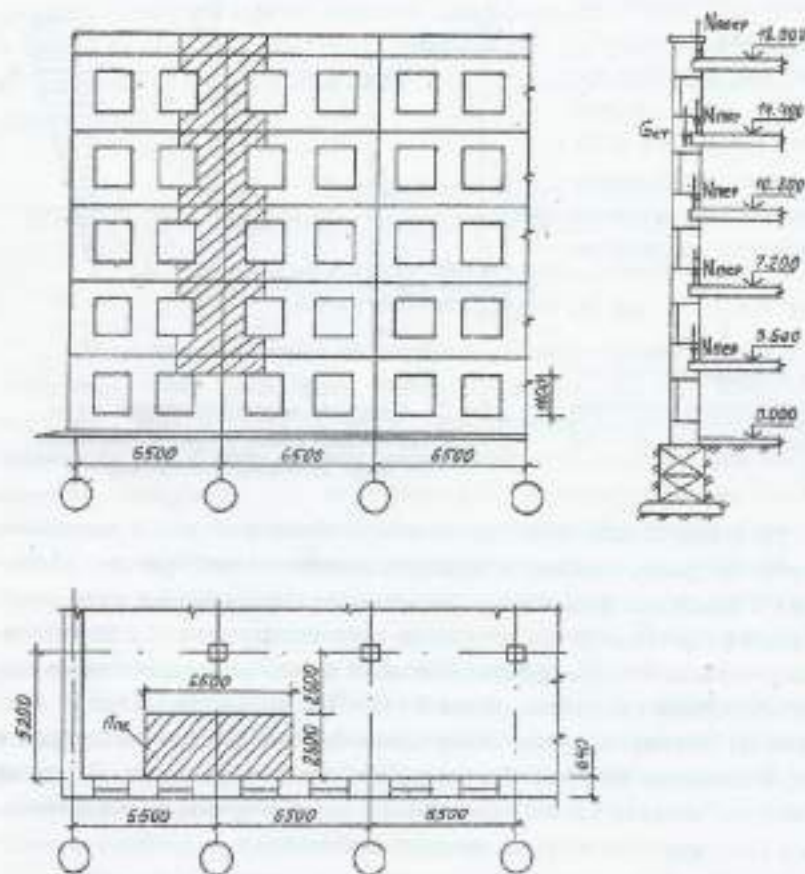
Фрагмент фасада и плана промышленного здания с расчету кирпичного простенка
